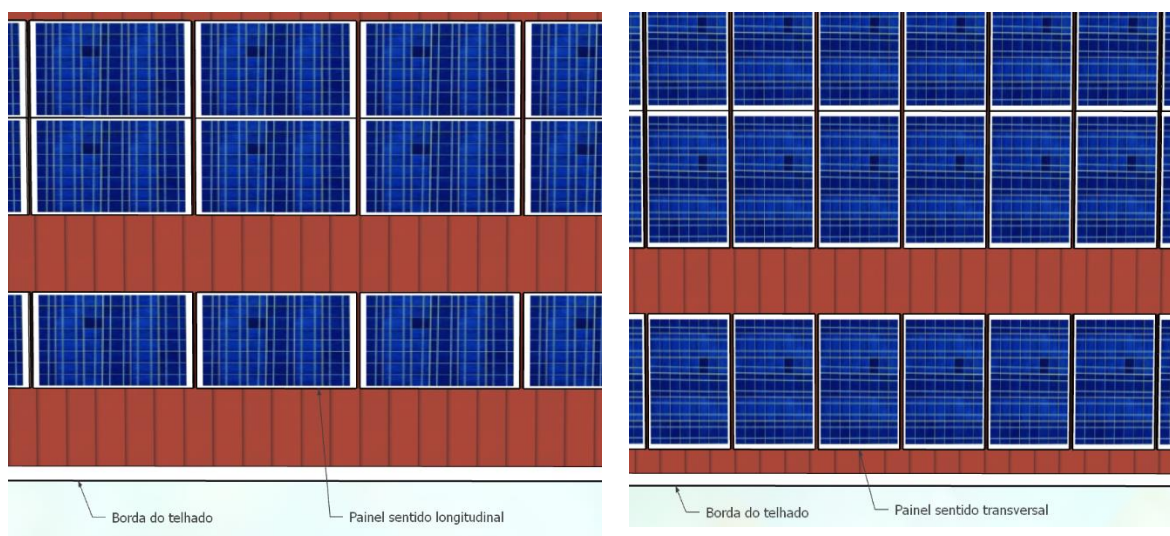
Painéis montados sobre os telhados no sentido transversal e longitudinal
